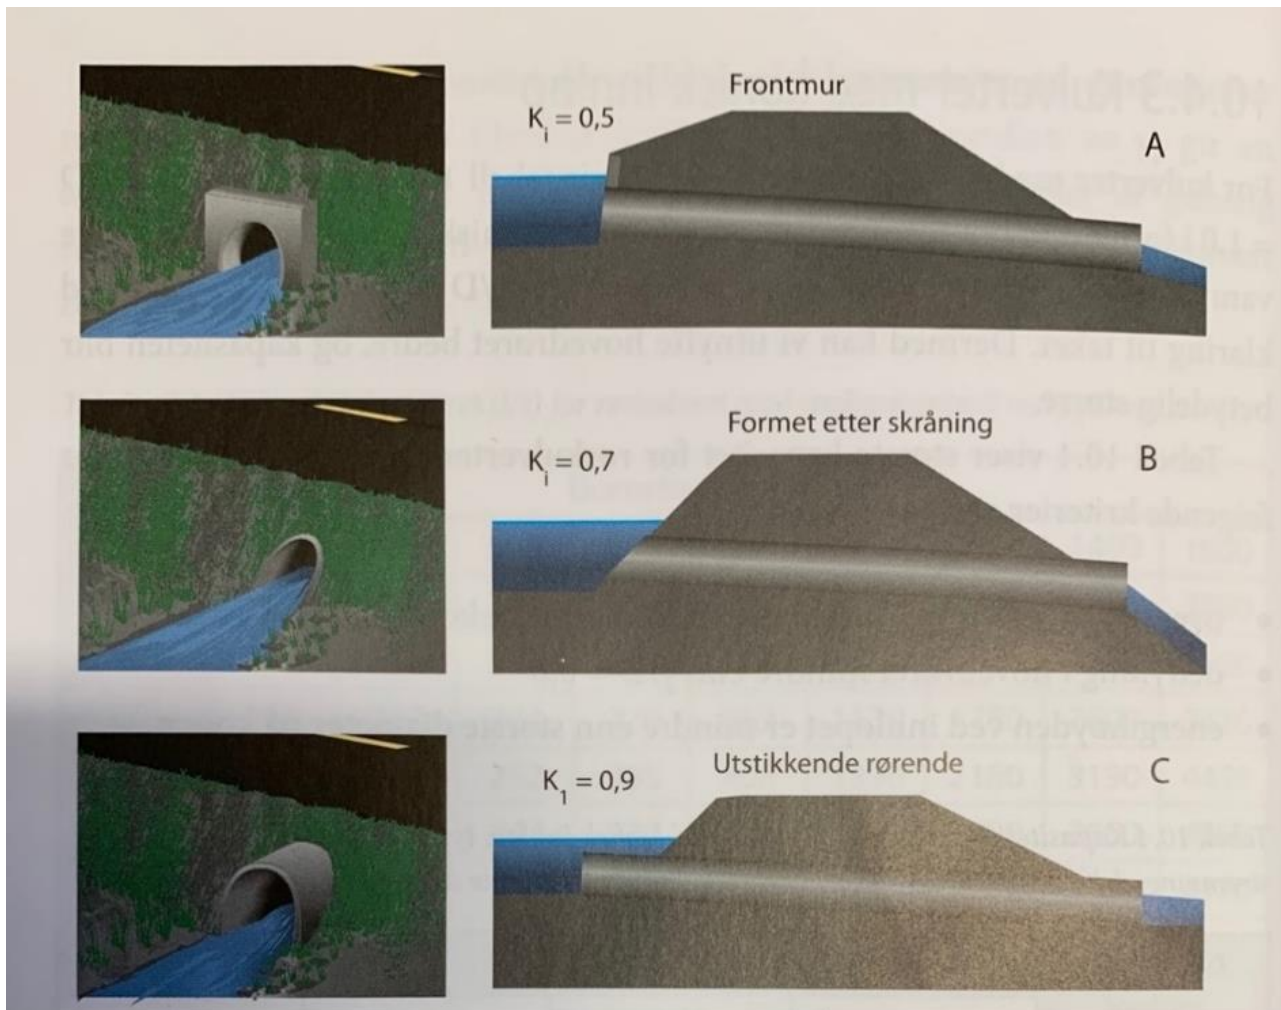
Dimensjonering av kulvert med gjentetting.
